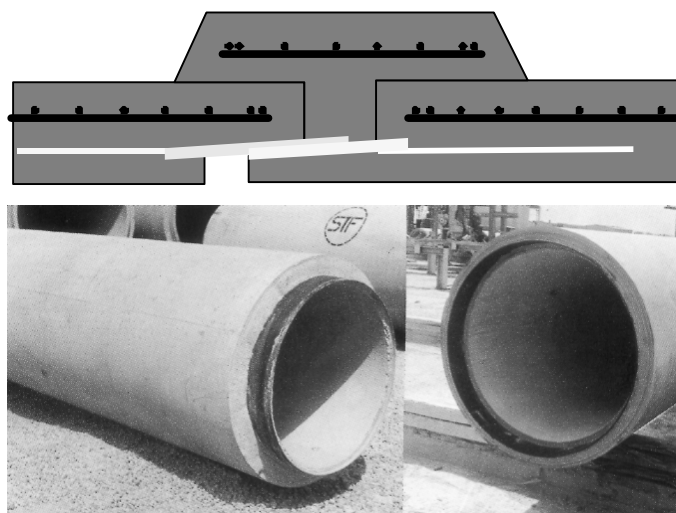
17. Unión por soldadura de la tubería de hormigón con camisa de chapa. Fte: Tubos Fábrega
